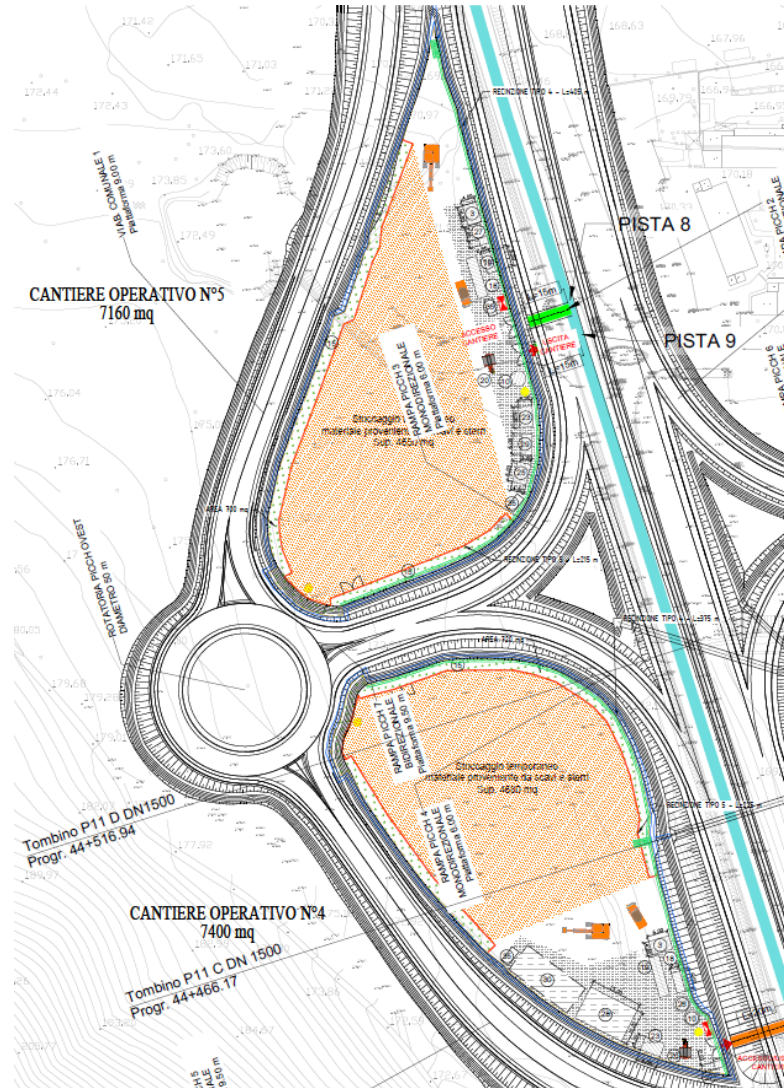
Planimetria cantiere operativo 4 e cantiere operativo 5.
